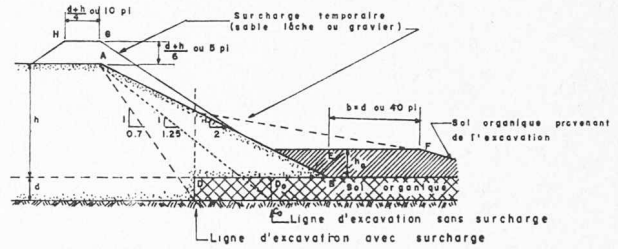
Sections types pour l'excavation des matériaux compressibles.
